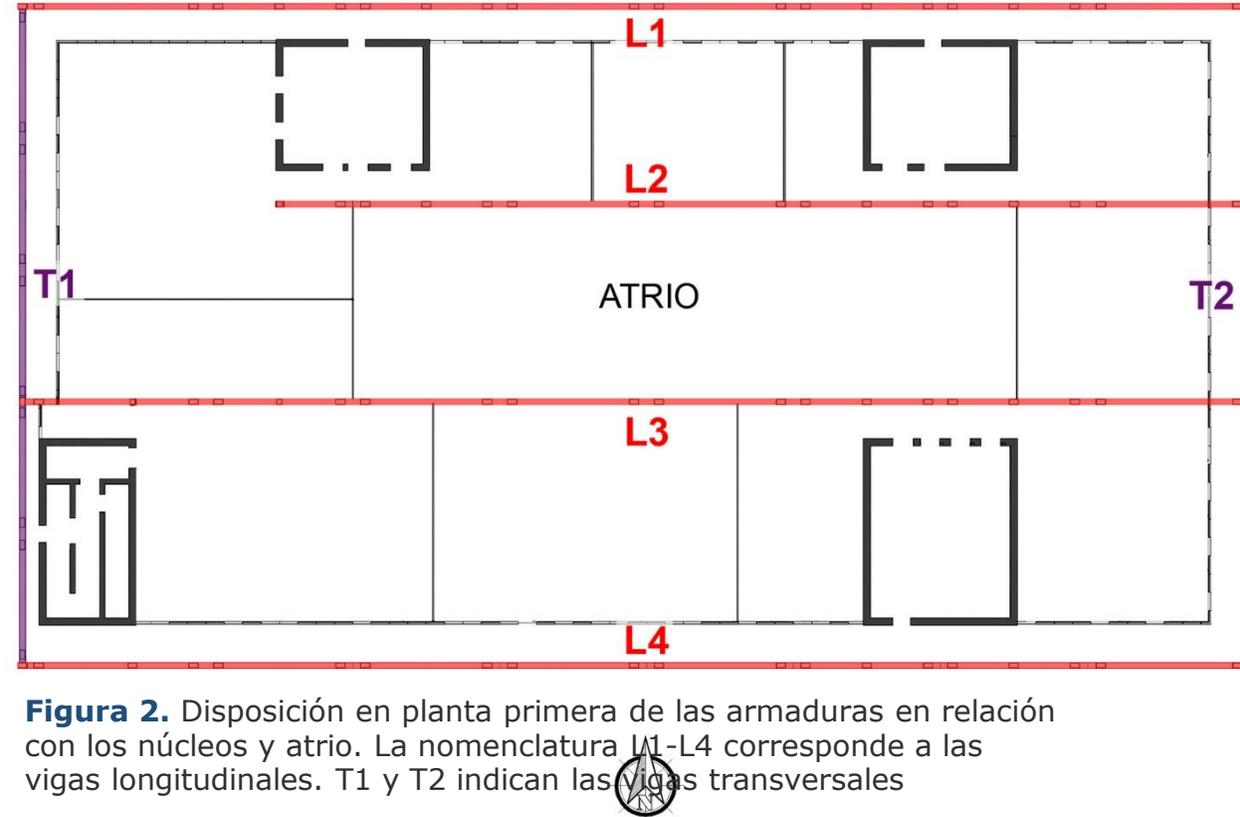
Disposición en planta primera de las armaduras en relación con los núcleos y atrio. La nomenclatura L1-L4 corresponde a las vigas longitudinales. T1 y T2 indican las vigas transversales
